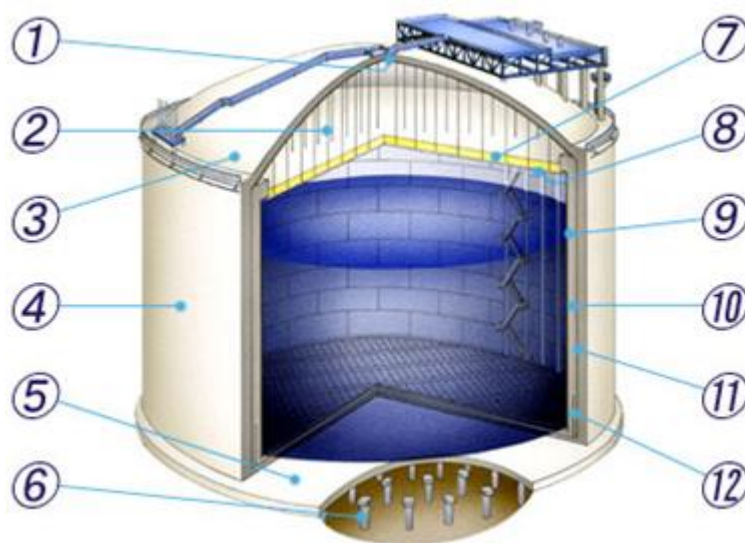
Конструкция железобетонного резервуара для хранения СПГ.
